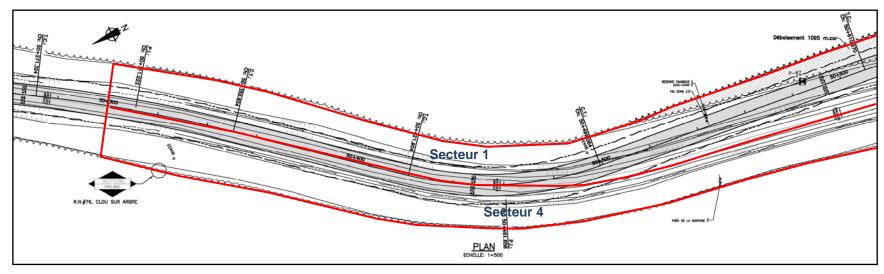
Localisation des secteurs inventoriés, projet nº 154-09-0220 (phase VI) (source : Ministère des Transports, plan d'ensemble [extrait], Terrassement et gravelage –Plan et profil, plan A1-GA16102-V-T605, 2 novembre 2004) (1/2)
